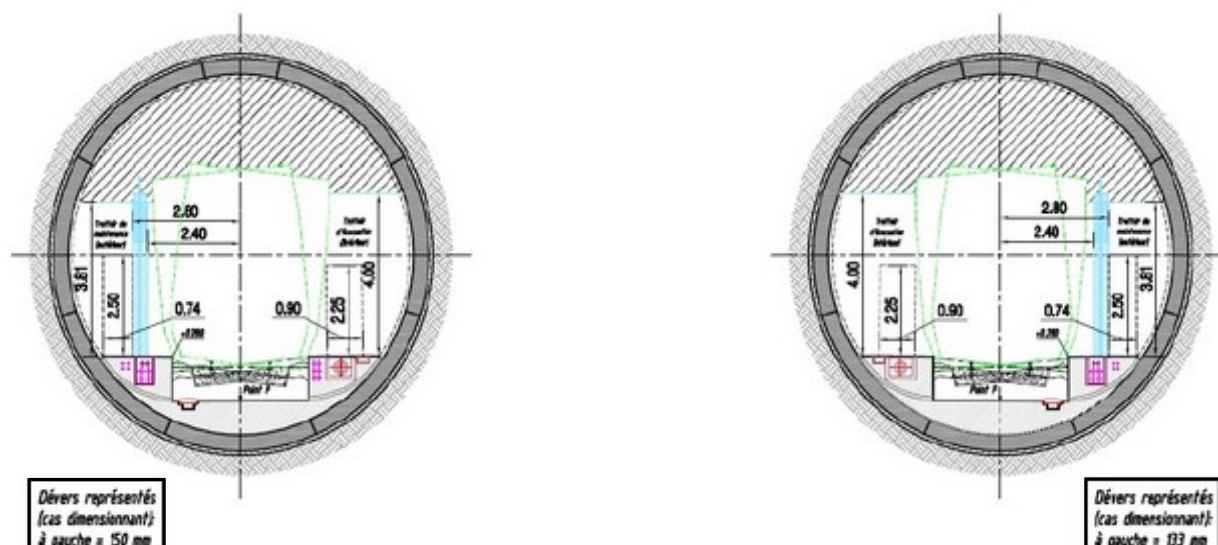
Croquis de principe des sections types de tunnel unidirectionnel
